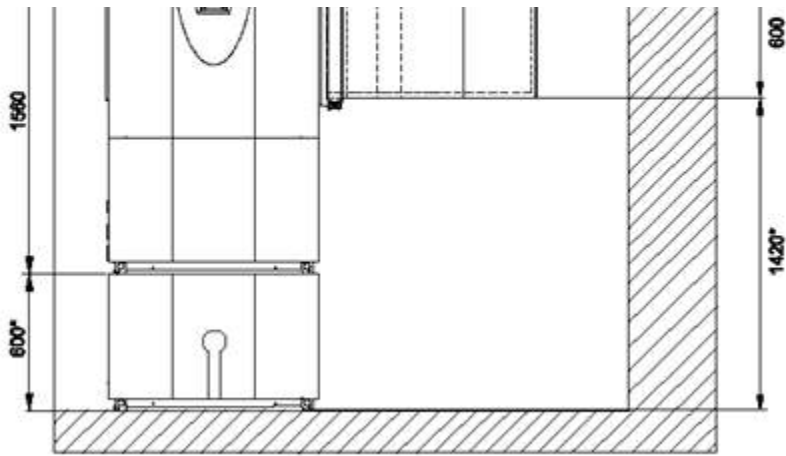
Vue de face - LI 9TU, LI 12TU et LI 16I-TUR (installation murale - conduit d'air côté refoulement)
